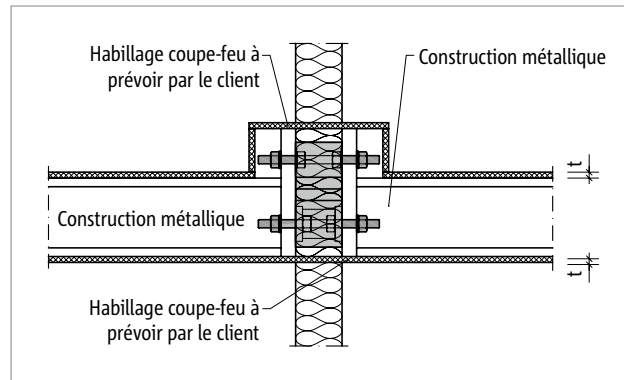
Protection incendie Schöck Isokorb® T type S : Bardage de protection incendie sur site pour plaques frontales saillantes ; coupe
